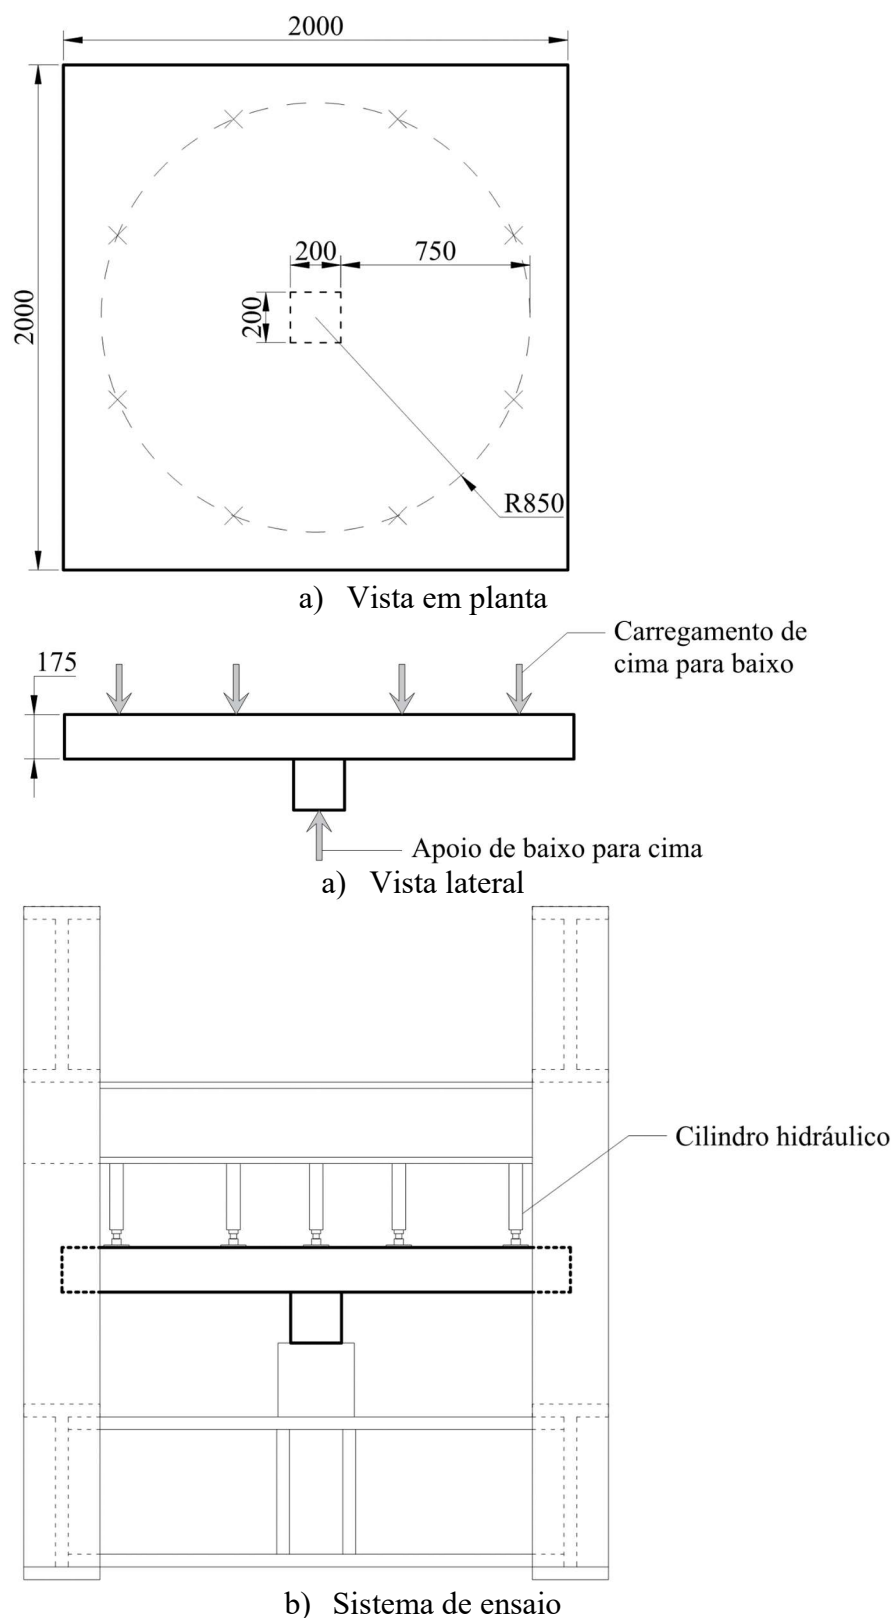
Lajes de Pilakoutas e Li (1997) – Dimensões genéricas e sistema de ensaio; cotas em milímetros
